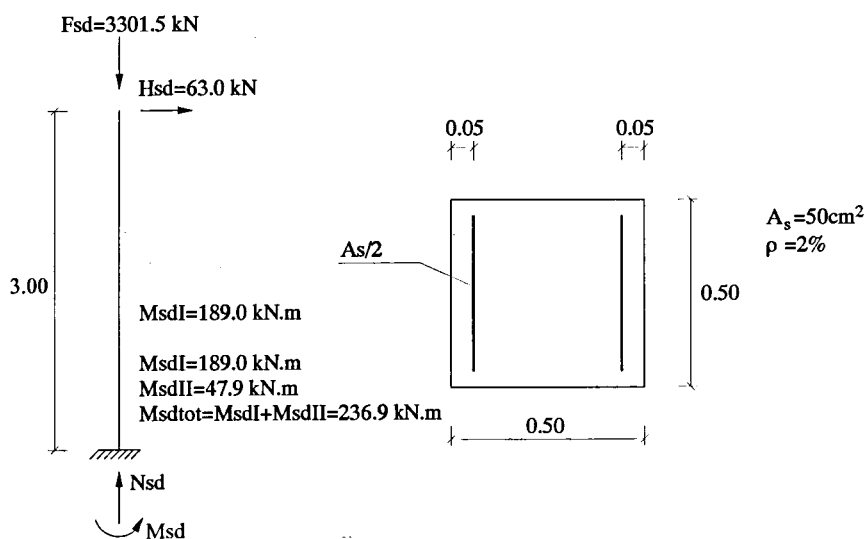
Pilar P1: Esforços de dimensionamento na base e armaduras
